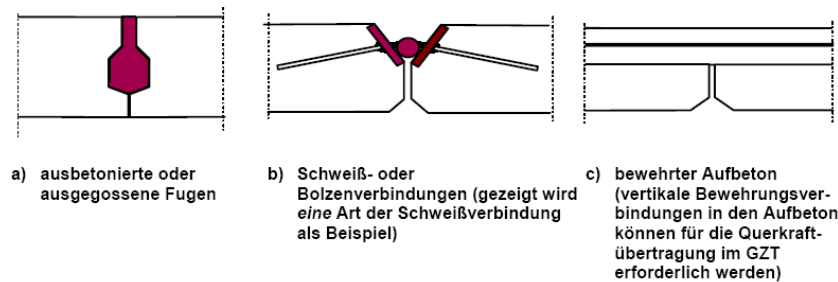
Deckenverbindungen zur Querkräfteübertragung (Beispiele)
